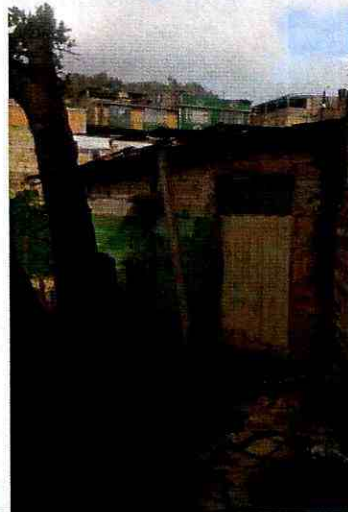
Vista del sector donde se ubica la vivienda de la Señora María Celina Pérez, ubicado al costado oriental del predio de la Tv. 7 B No. 68 B – 04 Sur.
